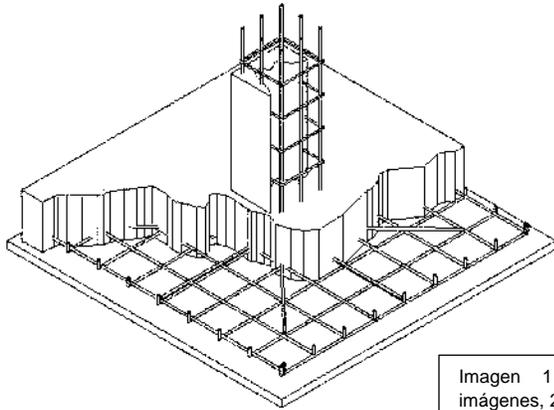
[Zapata aislada, Google imágenes, 21/06/2021]
